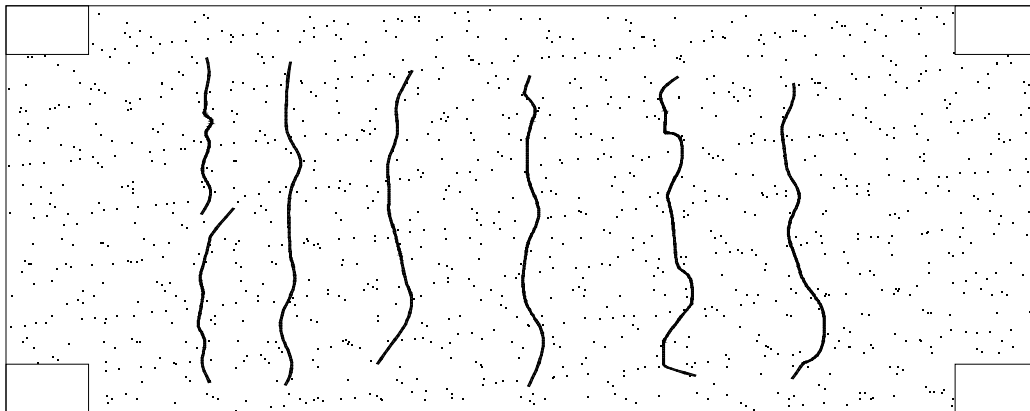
Fisuras de contracción hidráulica y térmica.
